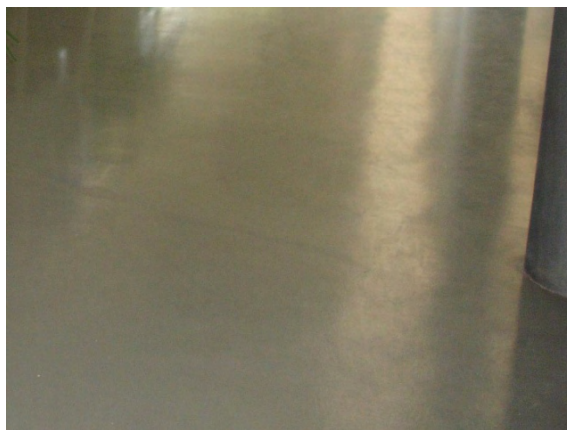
Pormenor do pavimento autonivelante epoxi
